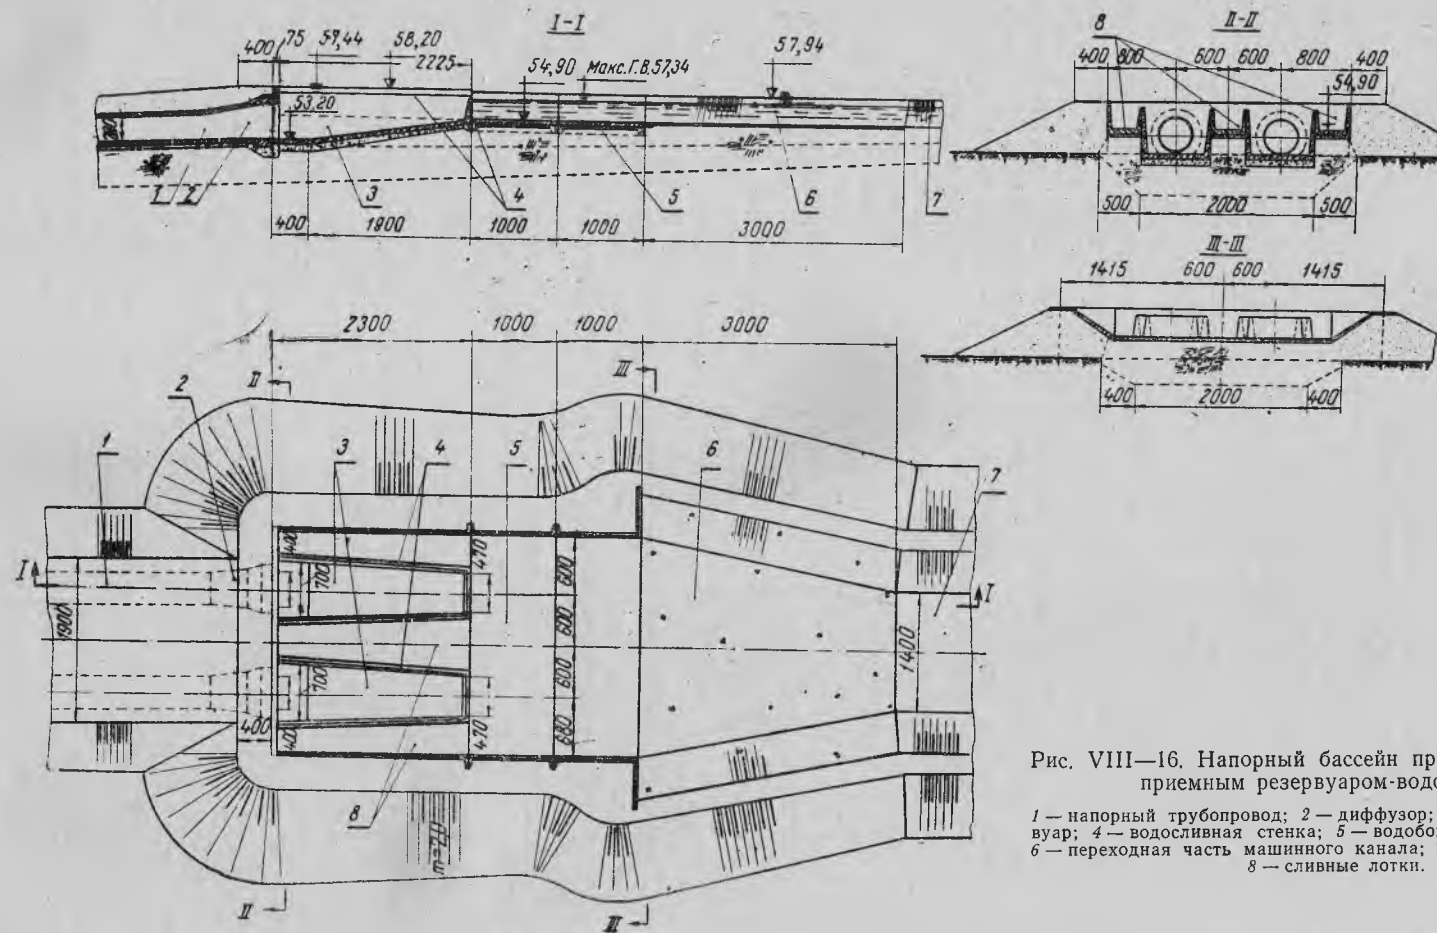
Напорный бассейн прямоточного типа с приемным резервуаром-водосливом:
